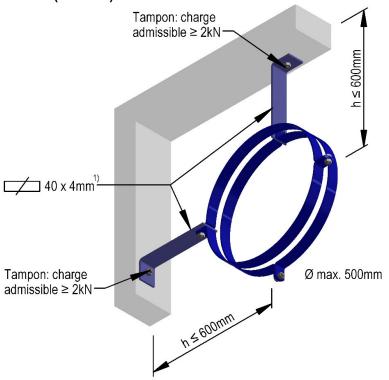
Fixation d'une conduite d'air sur entretoises horizontale et verticale (2 brides)
